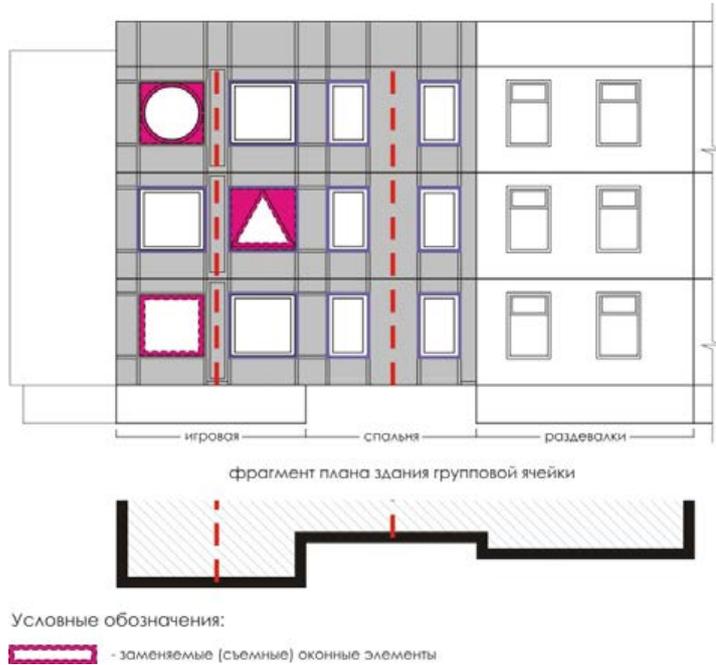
Фрагмент фасада здания ДОО с заменяемыми оконными элементами
